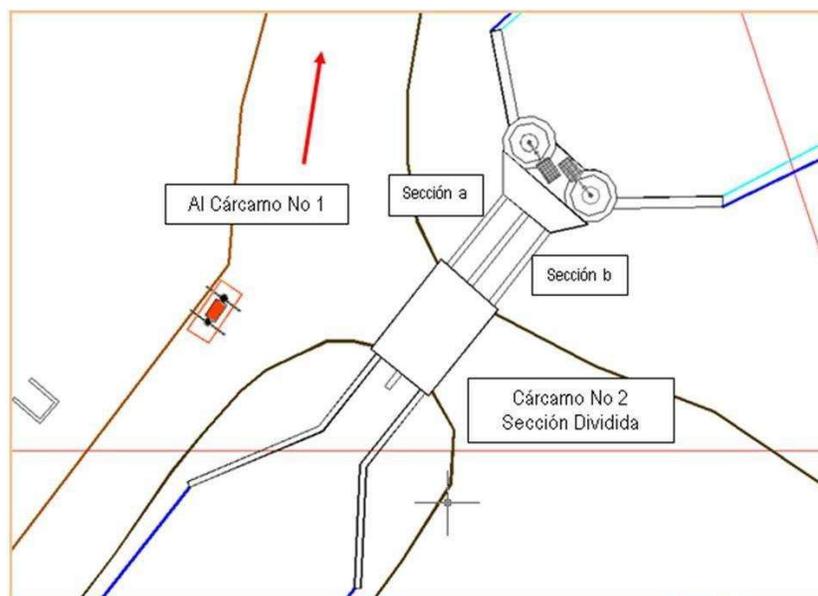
Planta general del cárcamo No. 2. (Guillen, 2008).
